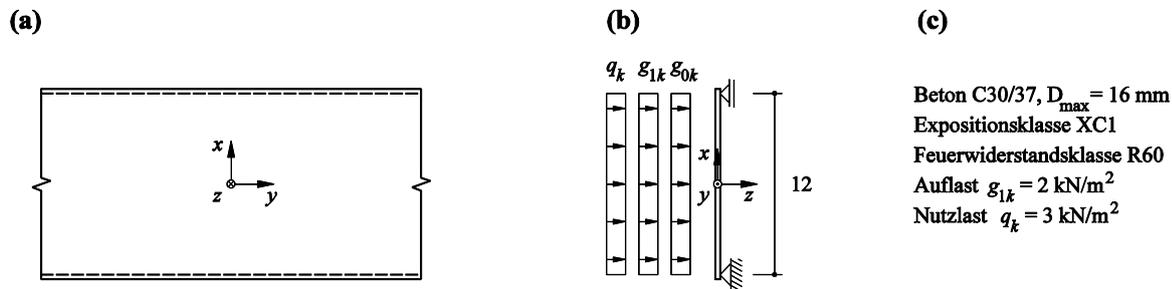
(a) Grundriss; (b) Ansicht und Belastung (Abmessungen in m); (c) Randbedingungen.
